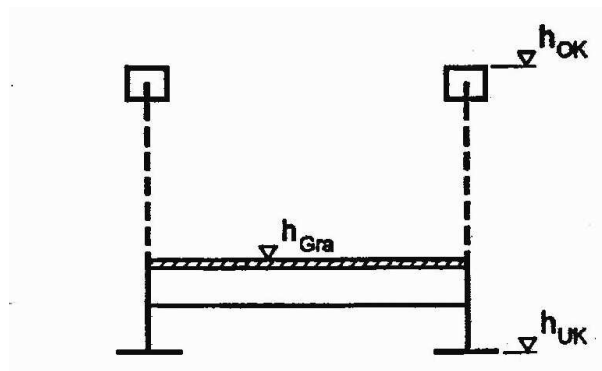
Bau- und Konstruktionshöhe, [14]
